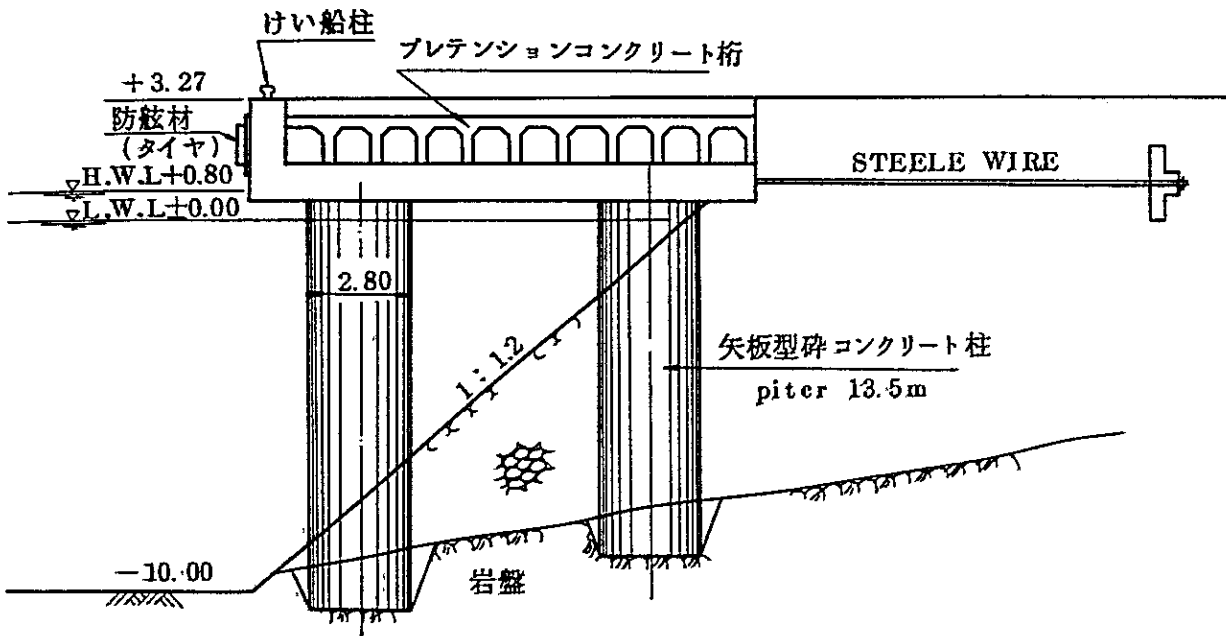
マタラニ港岸壁標準断面図 (鋼矢板セル式)
